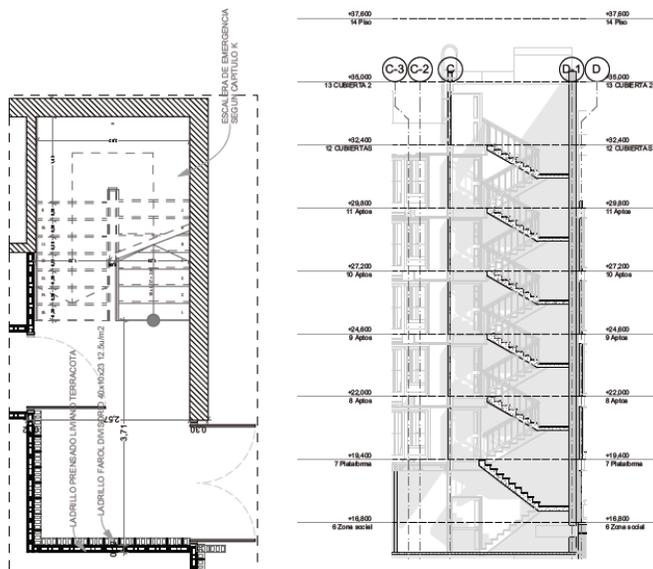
Plano de detalle de escaleras de emergencia para las torres de vivienda en altura. Elaboración propia.
